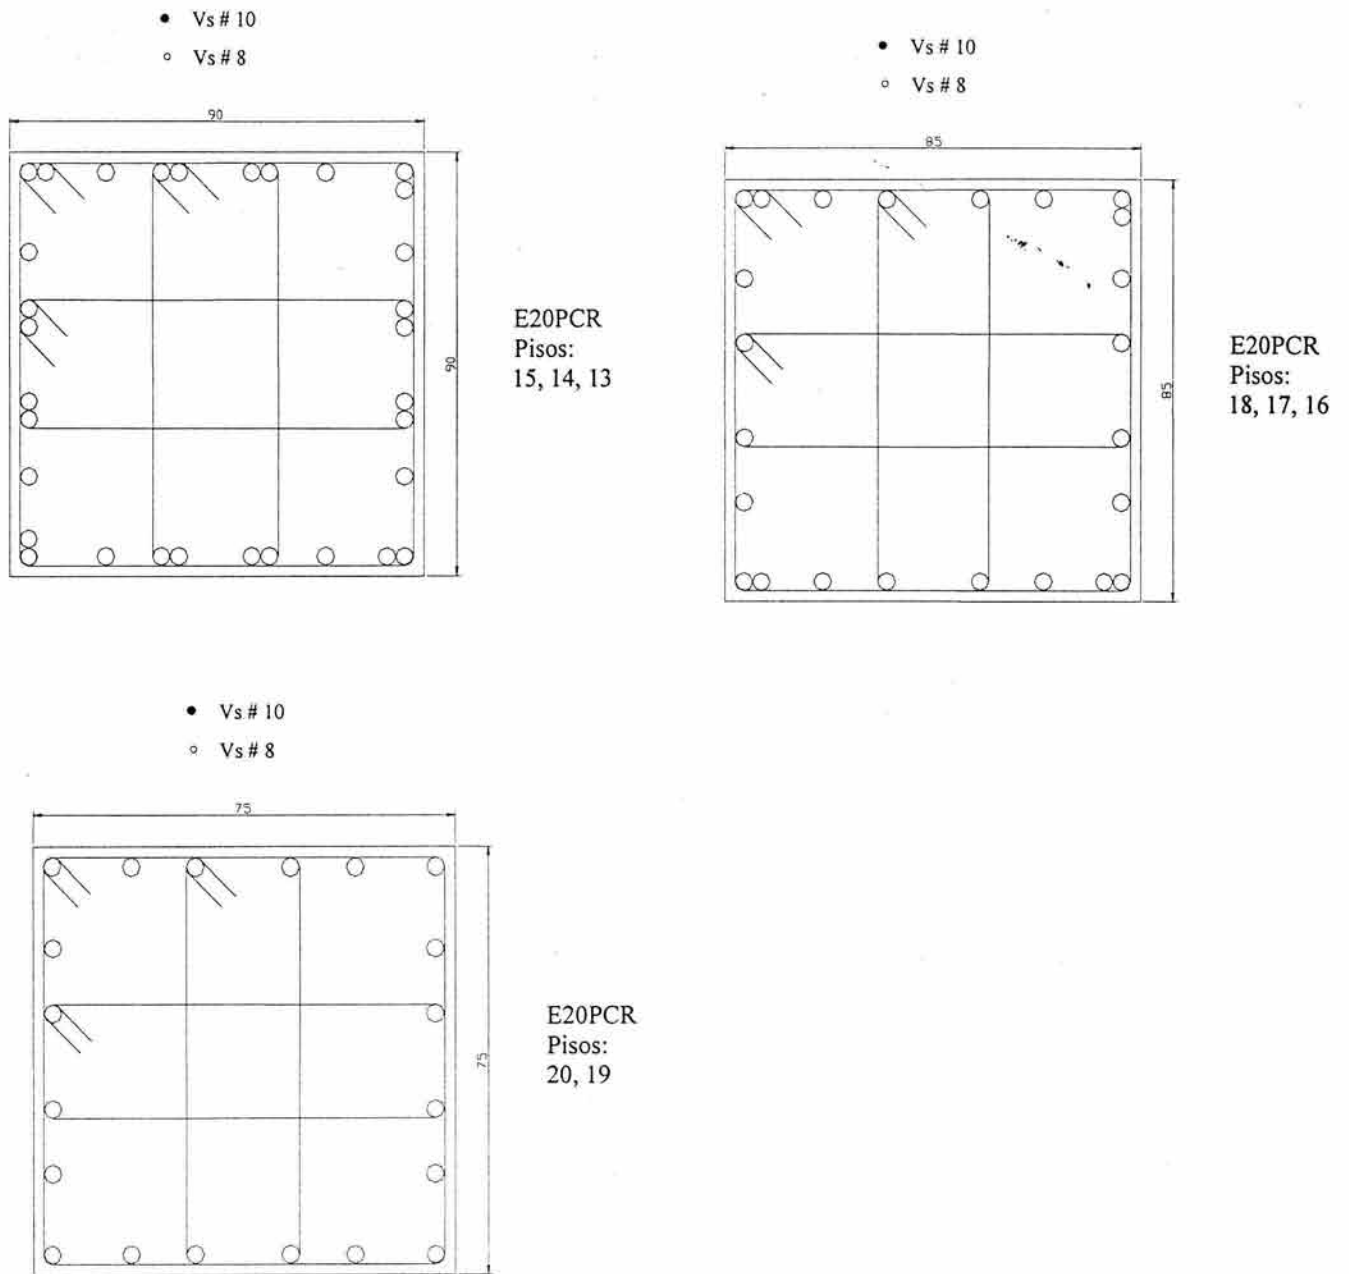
Detallado de columnas en edificio de 20 niveles, marcos exteriores (continuación).
